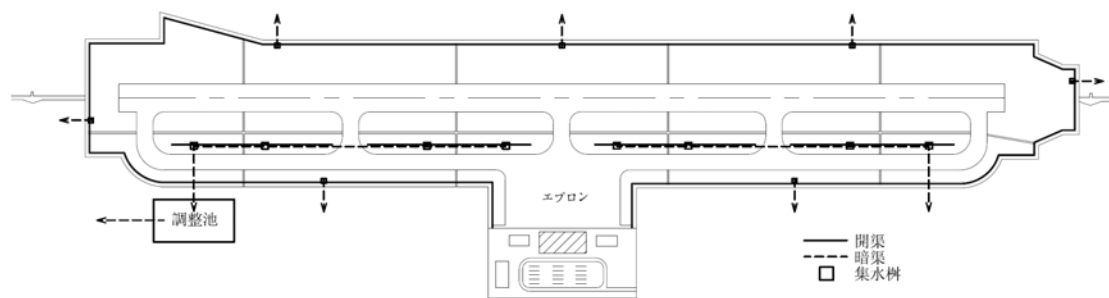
空港場内の排水系統の設定例および排水施設の配置例
